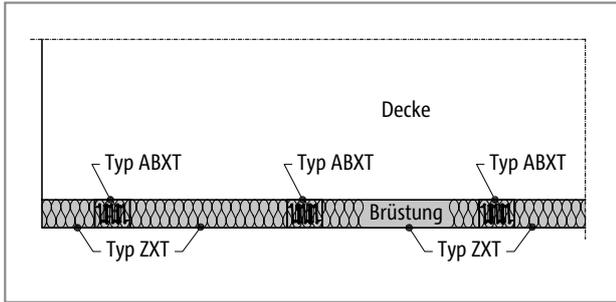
Schöck Isokorb® Typ ABXT vertikale Anordnung: Grundriss Brüstung aufgesetzt
